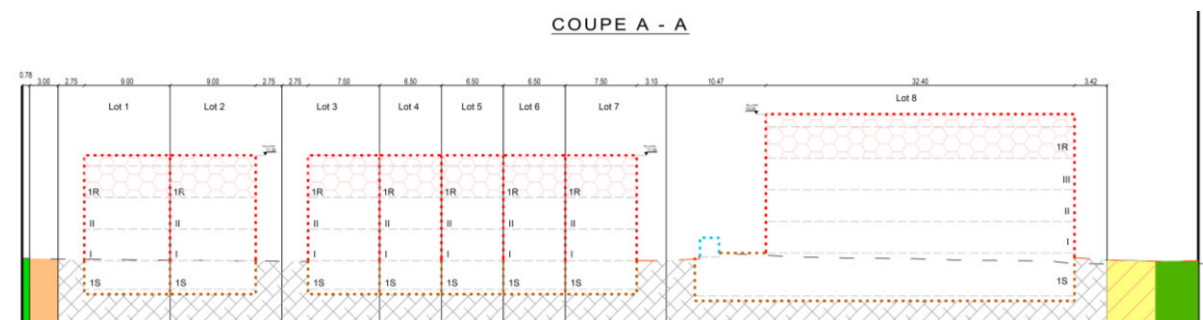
Coupes longitudinales des bâtiments. (Source : BEST)
